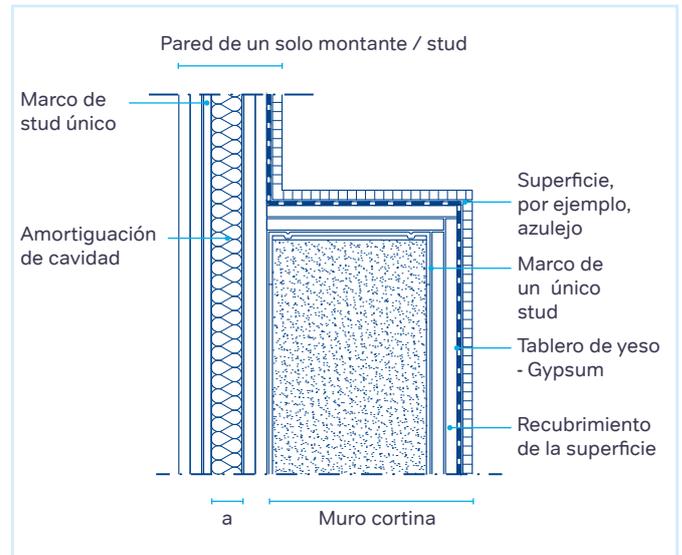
Muro de entramado simple con instalación de muro cortina adicional.
